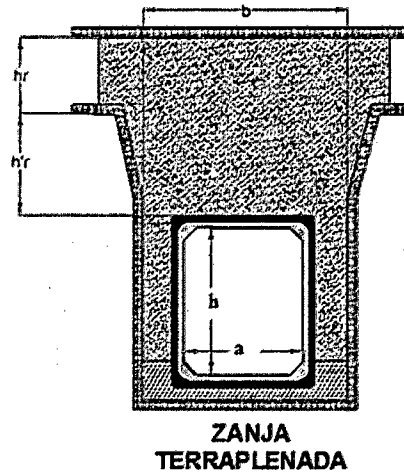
Marco de concreto armado con la instalación en zanja terraplenada
